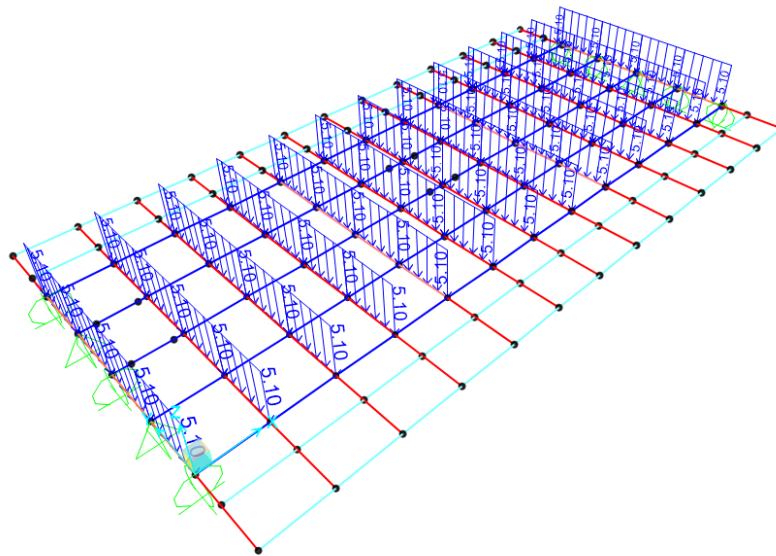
Applicazione al modello agli EF dei carichi permanenti non strutturali G2\_pavimentazione
